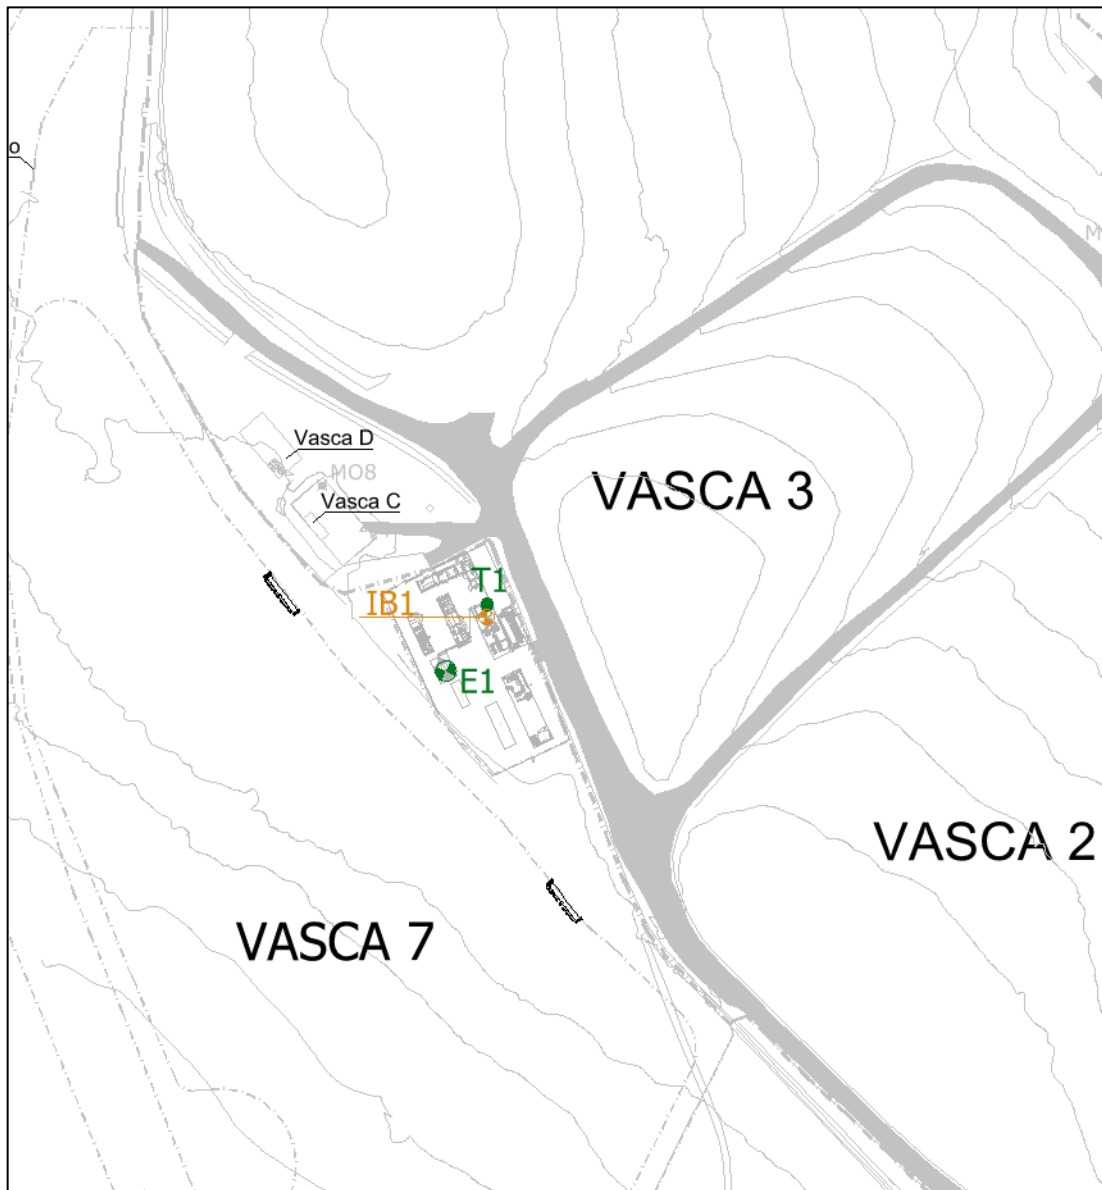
Stralcio planimetrico punti di monitoraggio impianto biogas Ascoli 1
